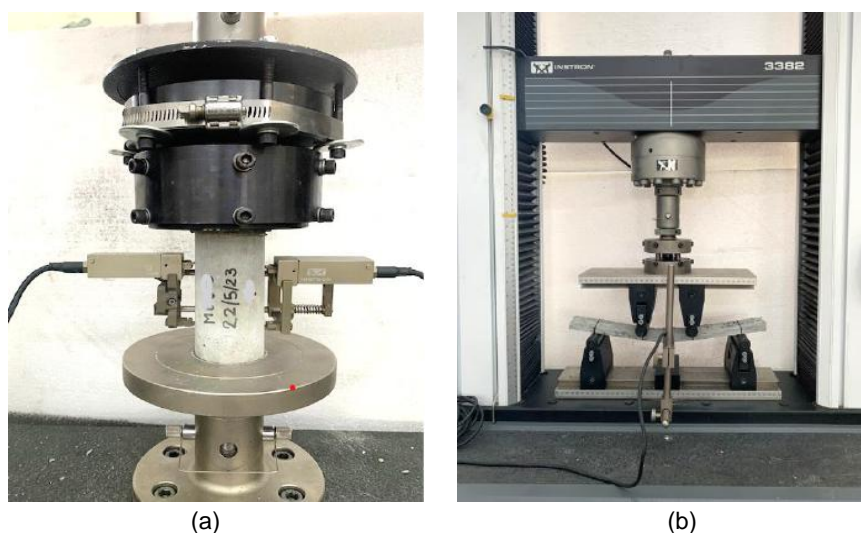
(a) Ensaio de compressão e (b) ensaio de flexão durante carregamento.
